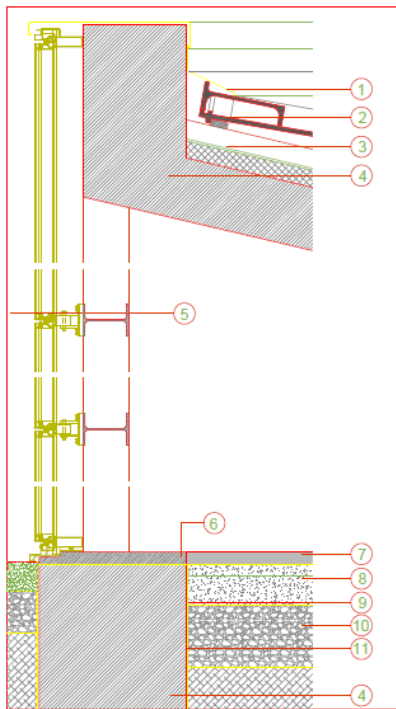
a) Pormenor construtivo da estrutura metálica da fachada de vidro, corte V4.
